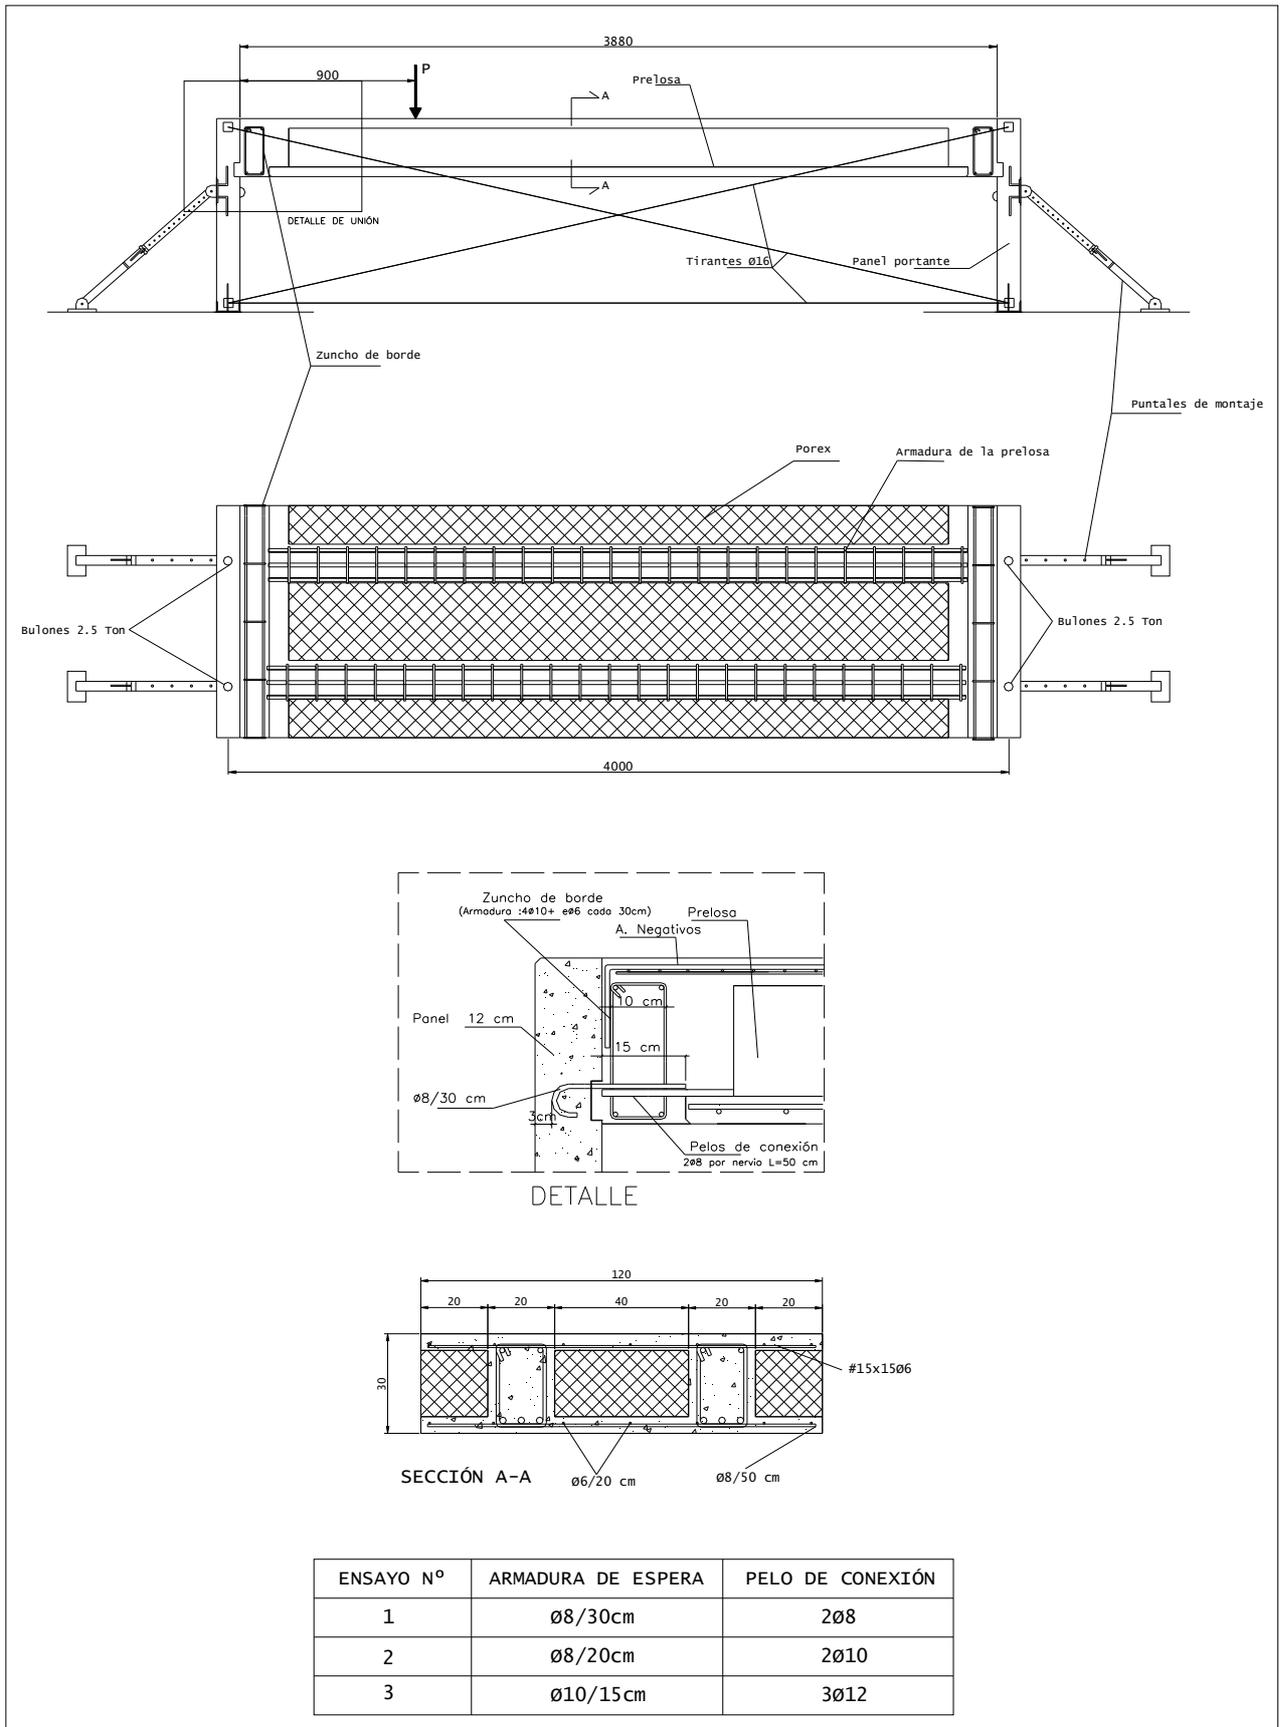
DISPOSICIÓN DEL ENSAYO DE LA JUNTA LOSA-PANEL
